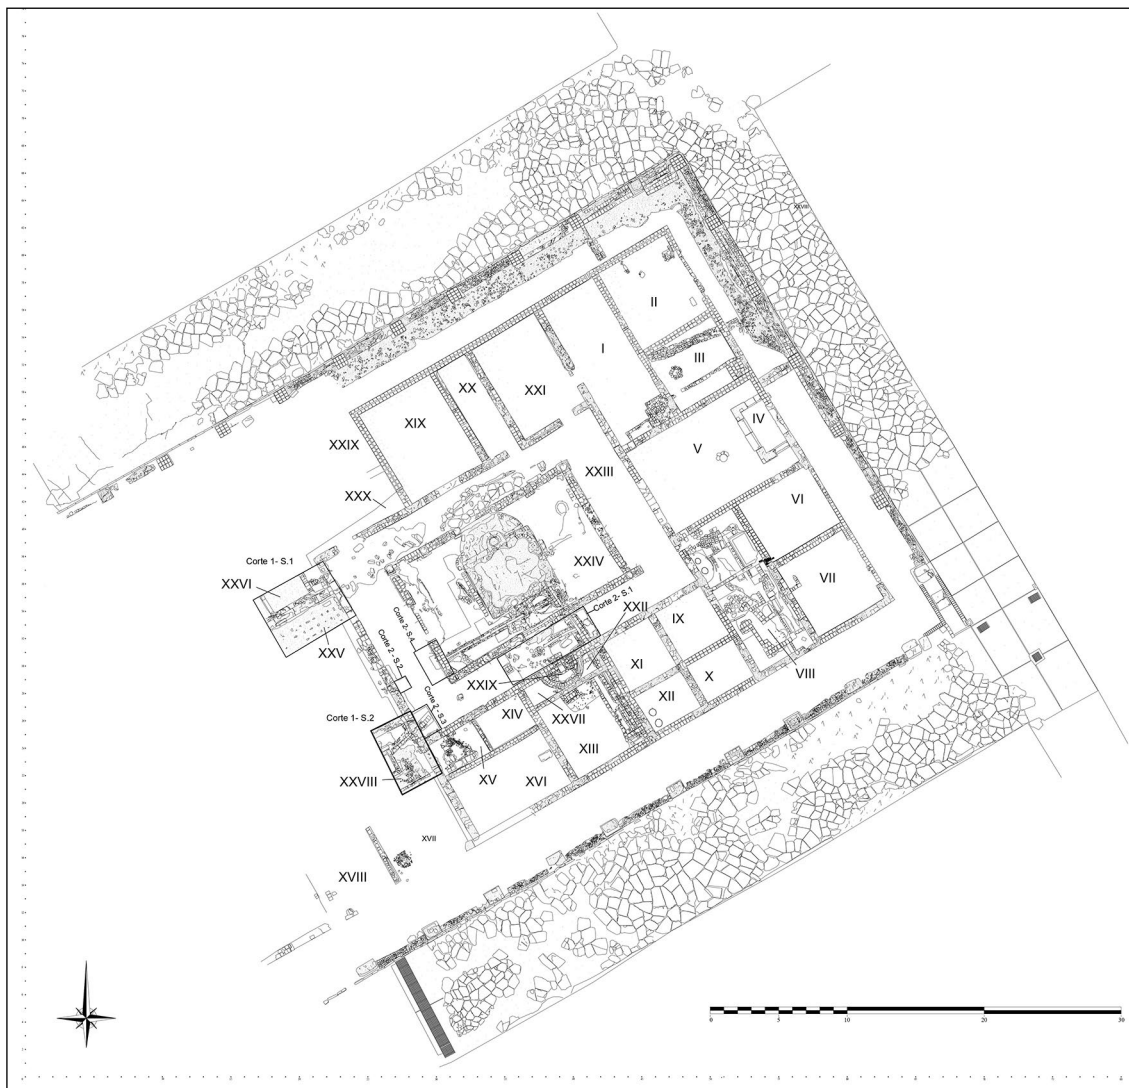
Planta de la Casa de la Cañada Honda de Itálica
